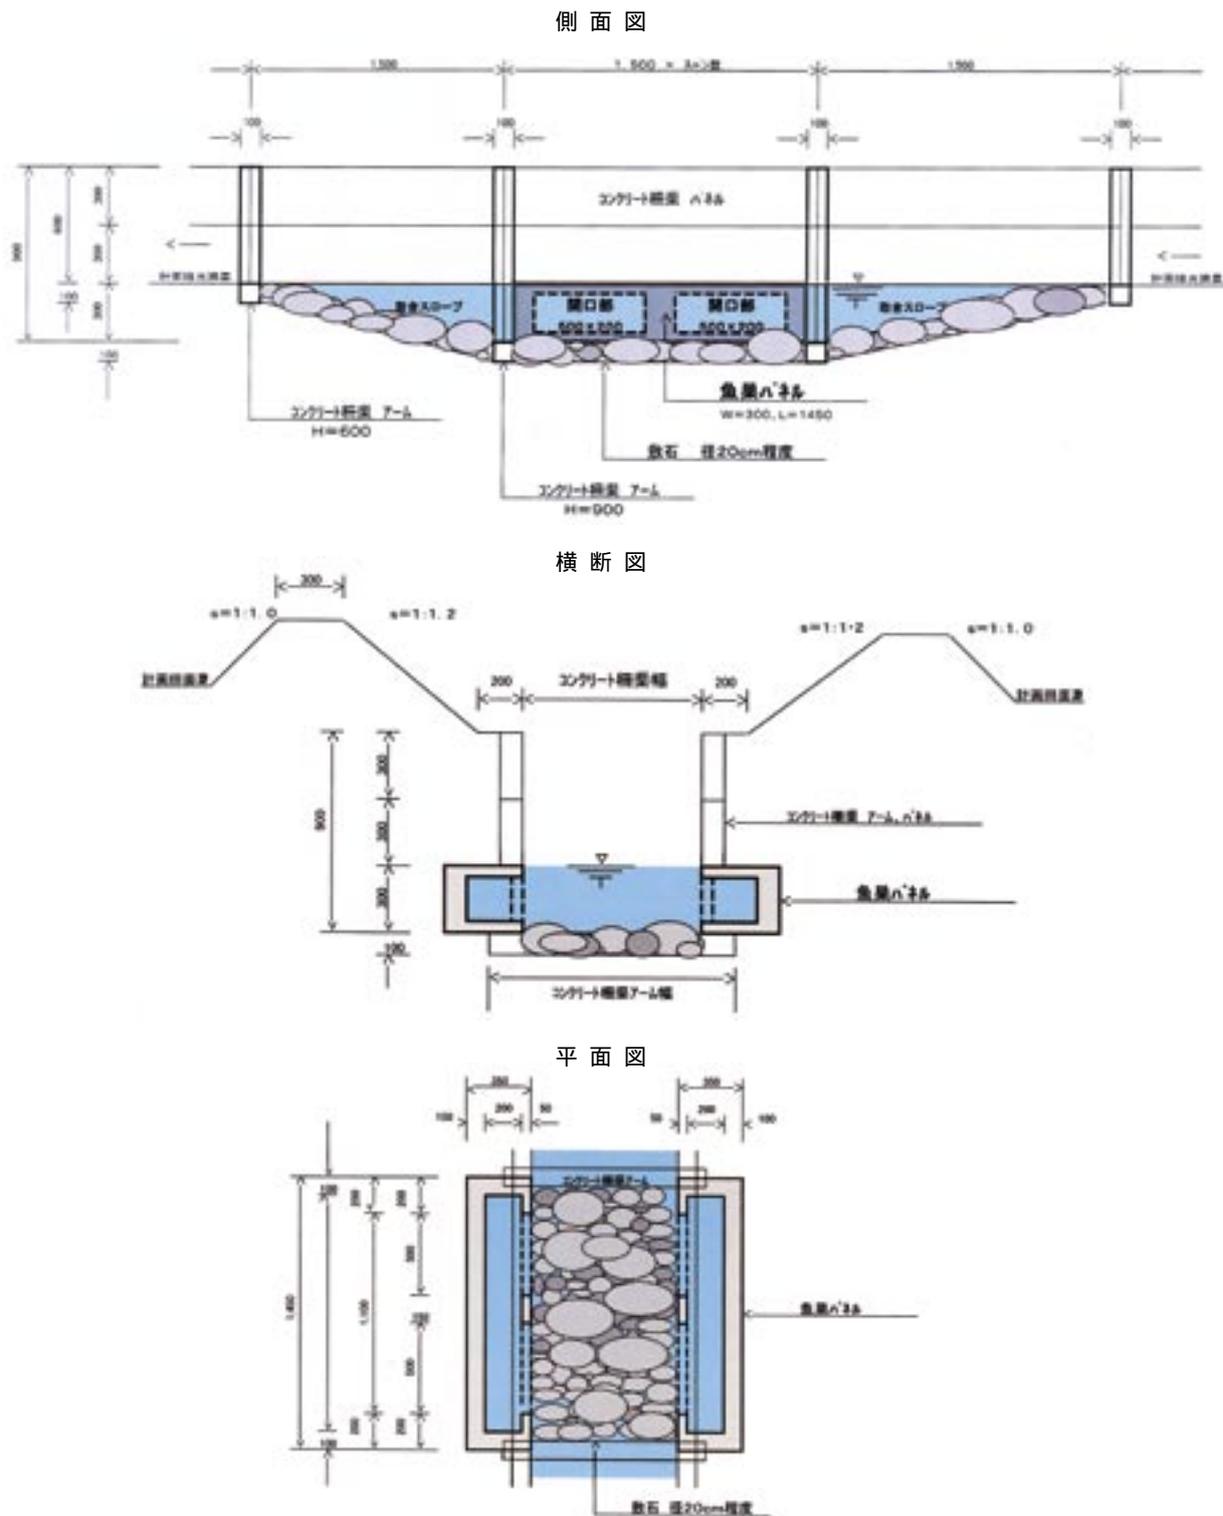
ほ場整備事業における漁巢工法（側面図、横断面図、平面図）
